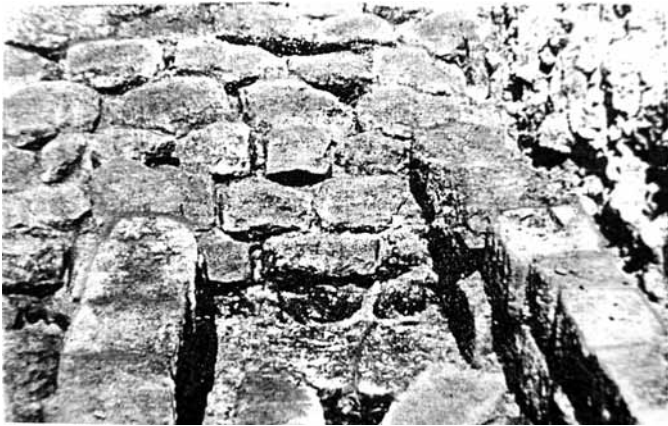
Dovelas de mayor tamaño en la parte baja del puente de Caparra.
